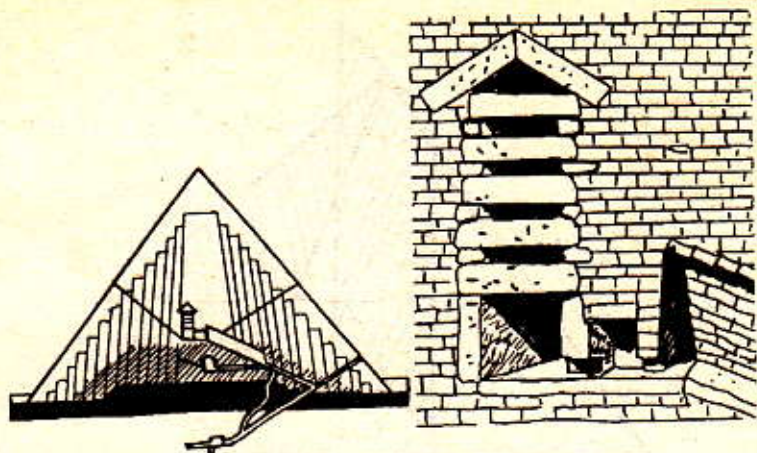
Перекрытие погребальной камеры пирамиды Хеопса
